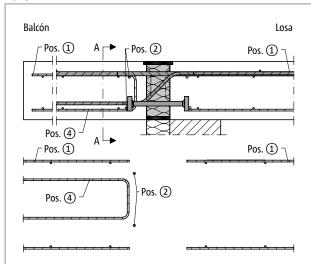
Schöck Isokorb® T tipo K-M12: Armadura in situ en caso de apoyo directo
